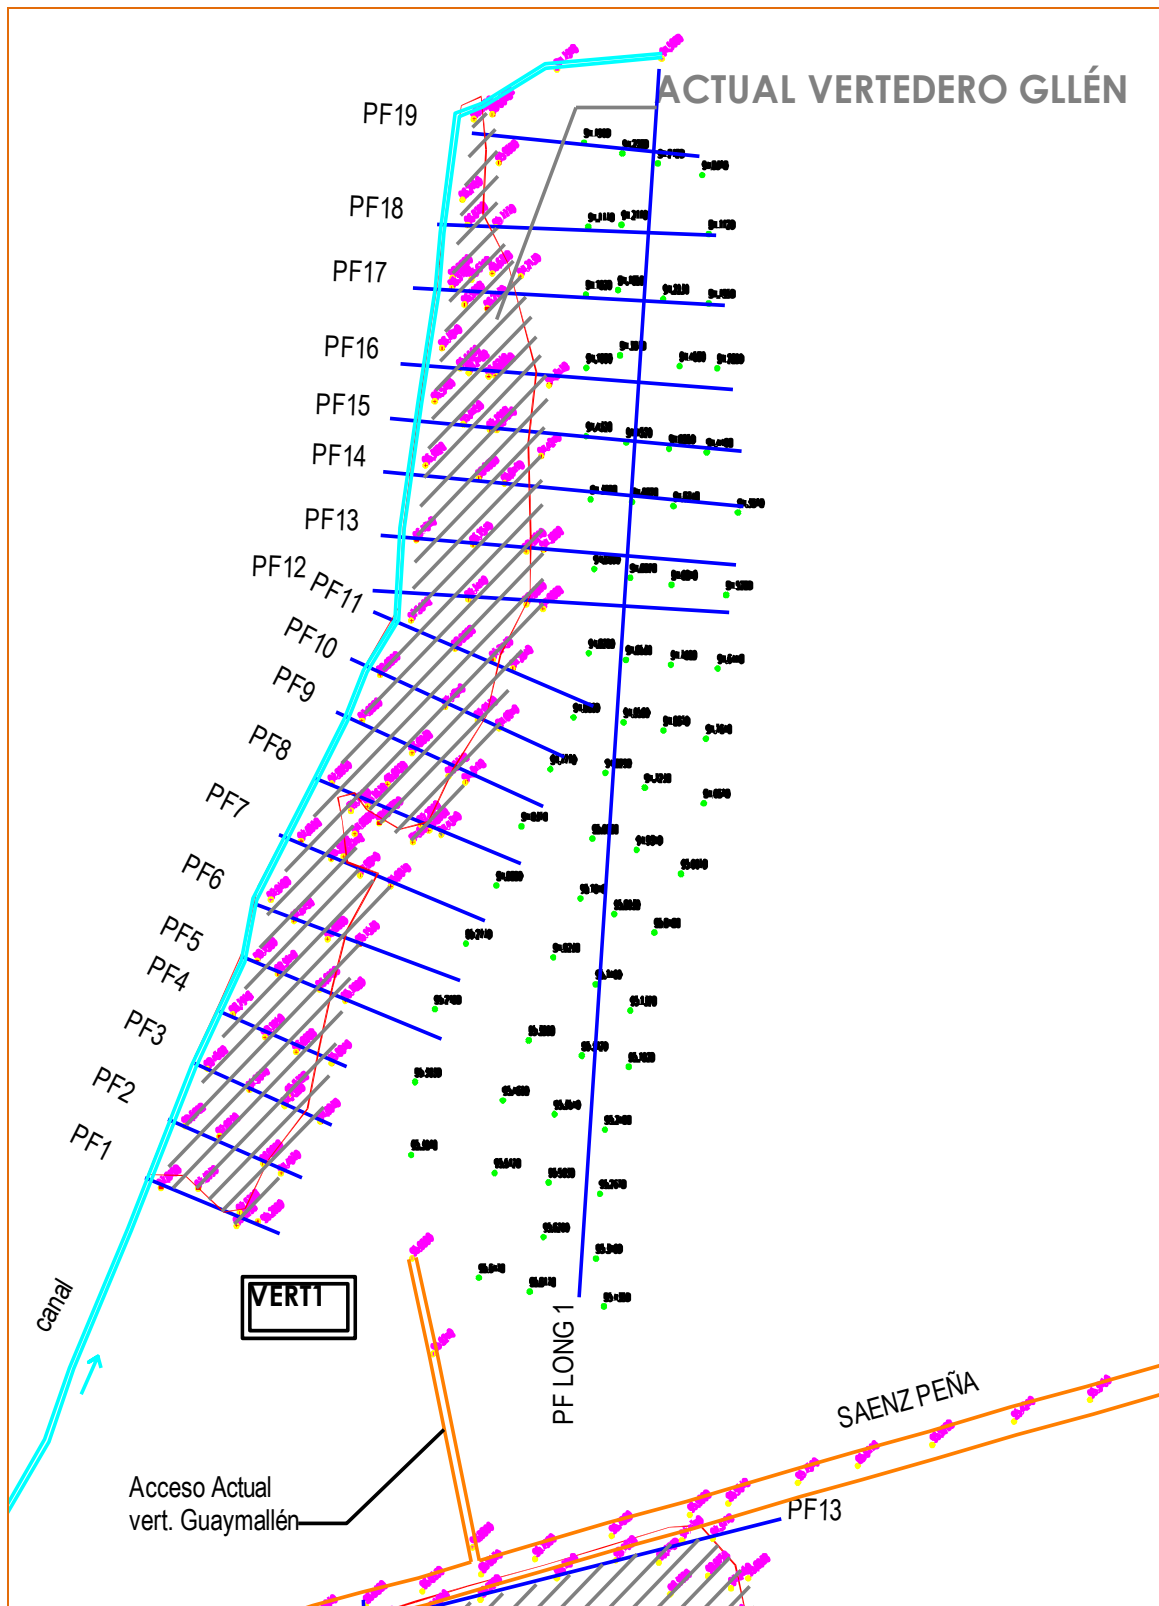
Detalle de la Planimetría Actual Vertedero de Gllén.
